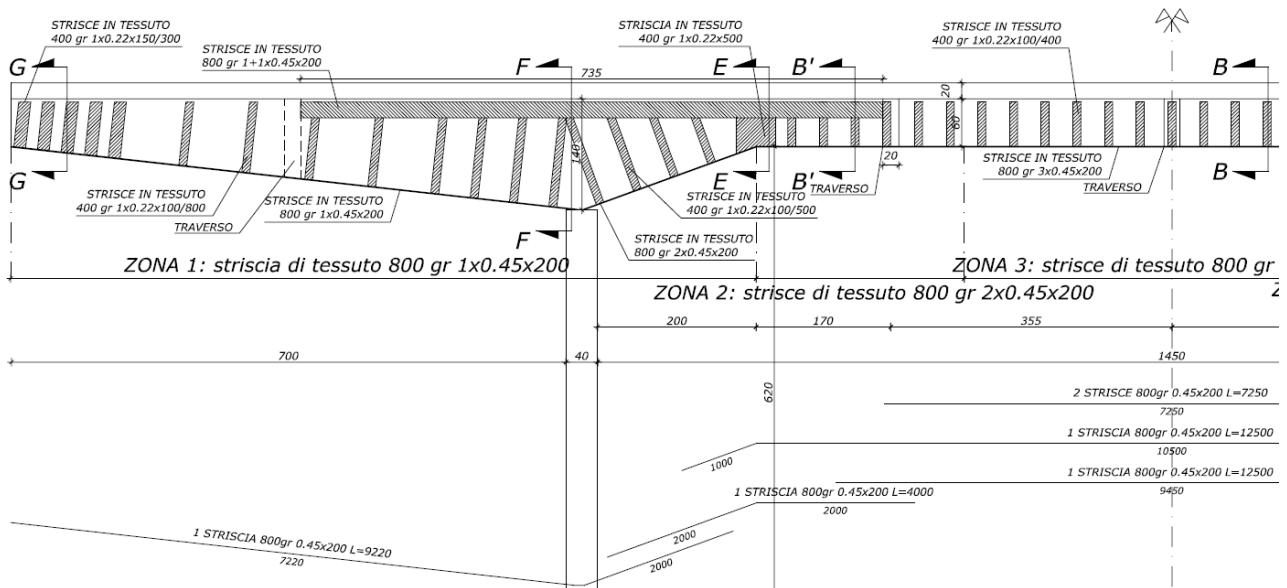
Schema di disposizione delle strisce in C-FRP sulle travi esterne
